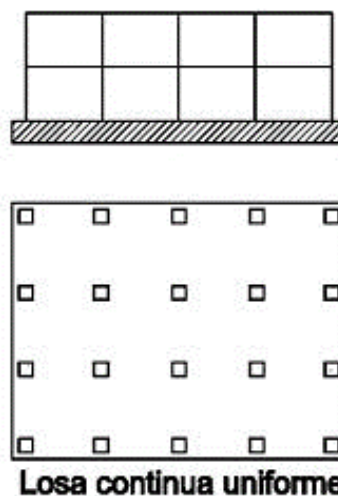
, tipos de platea de cimentación, fuente libro de diseño estructural.
